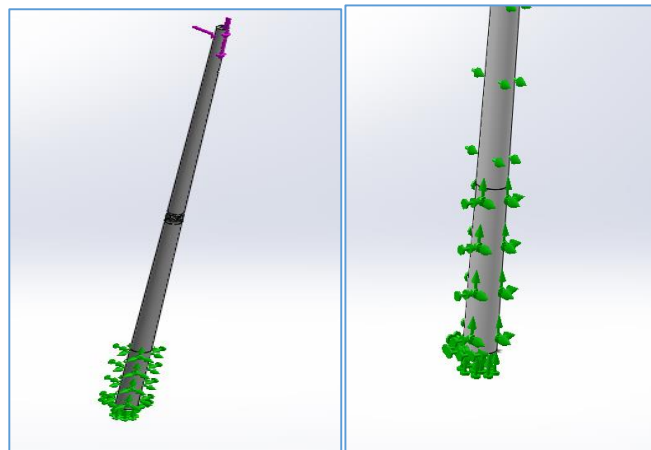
45. Vista de la zona de anclaje del poste, cimentación.
